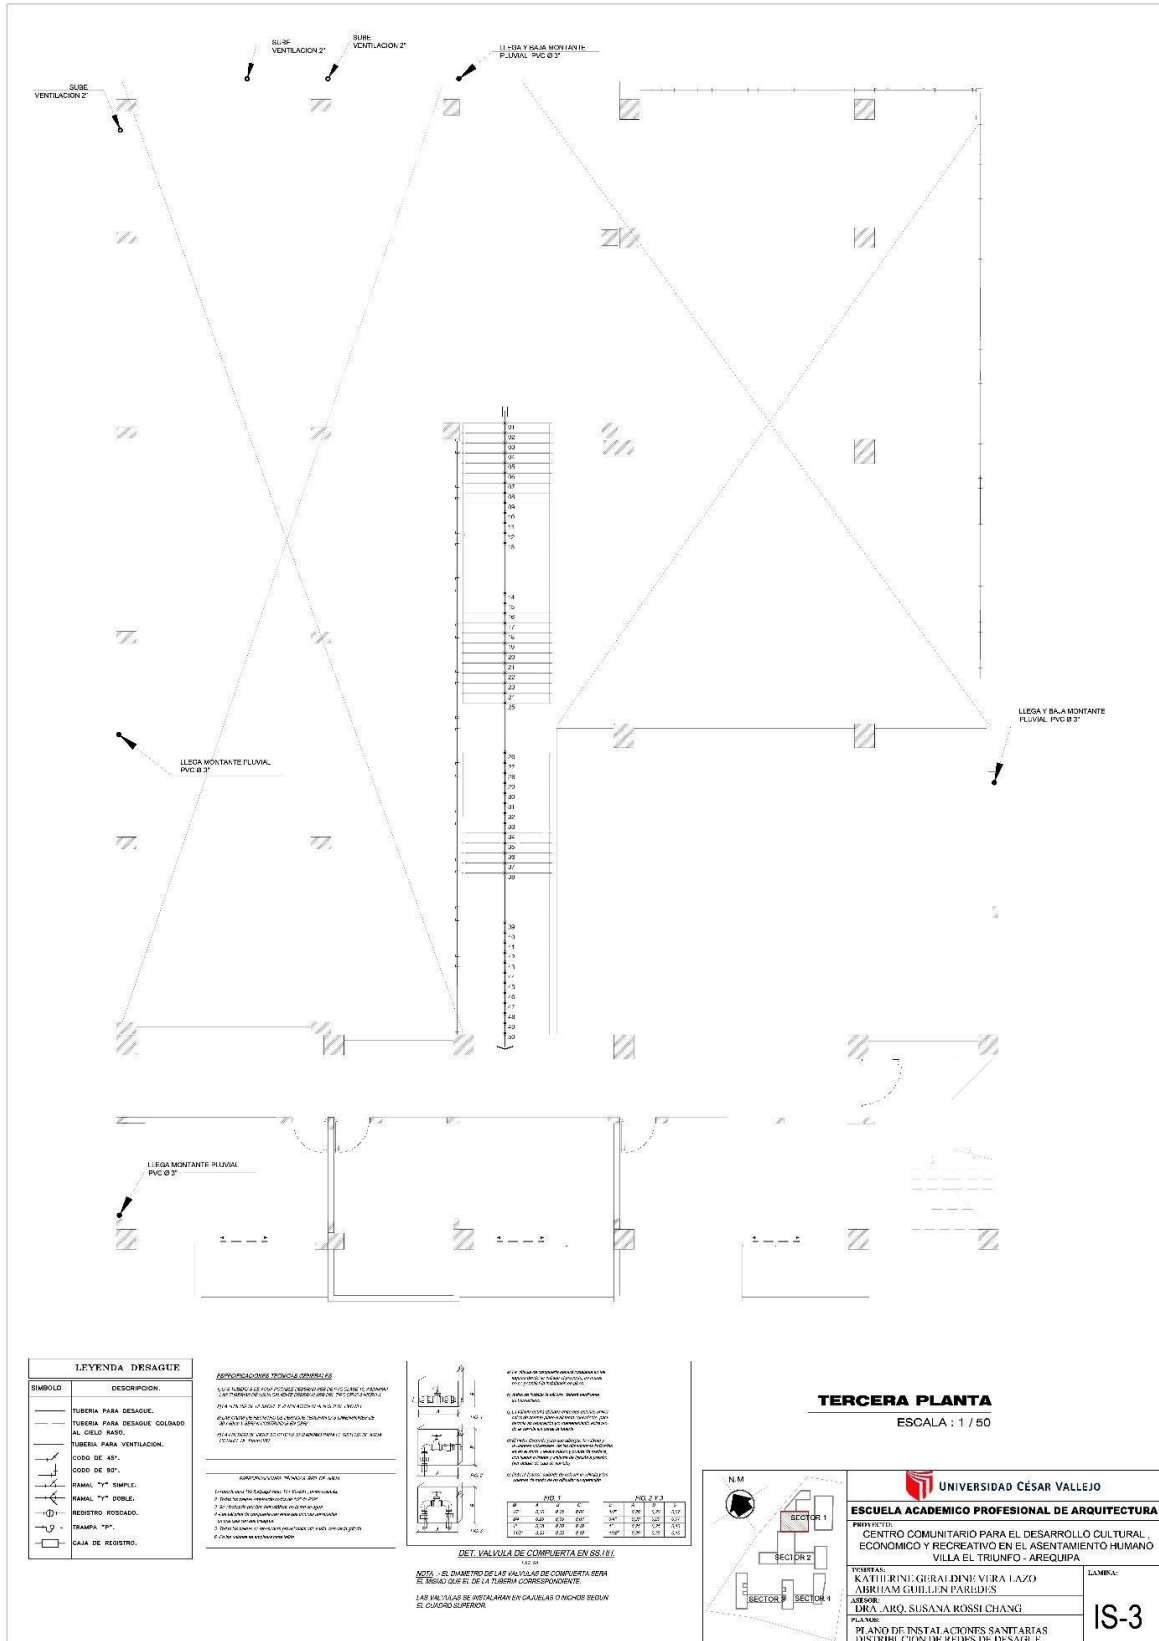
Plano de distribución de redes de desague y drenaje pluvial Tercera Planta - Elaboración propia
